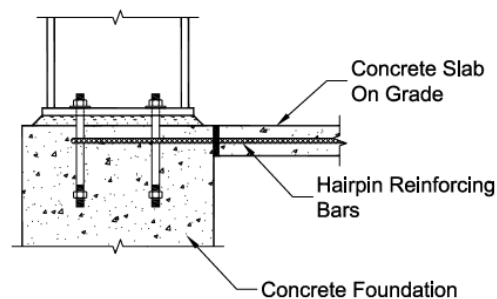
Detallado típico usando barras de horquillas. Tomado de *Design Guide No. 1: Base Plate and Anchor Rod Design (p.1)*, por American Institute of Steel Construction, 2006. Copyright 2006 por AISC.
